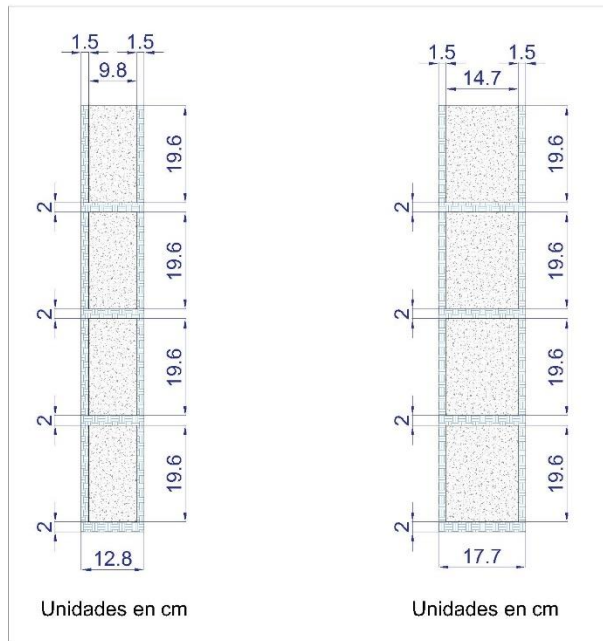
Unidad de análisis para mampostería de bloque de hormigón alivianado de 10 y 15 cm - Vista Lateral
